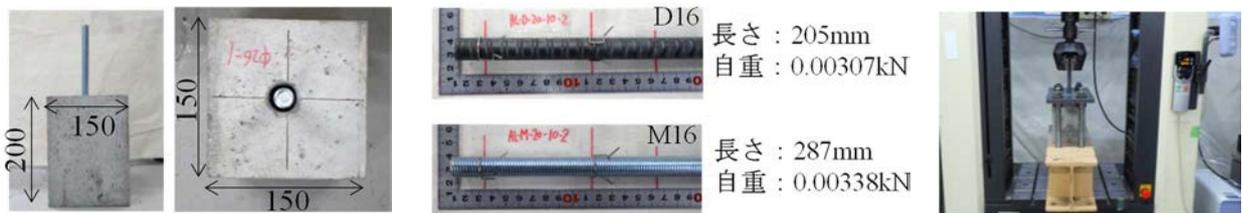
コンクリートブロック 写真-4 クリップ型ばねを装着したアンカー筋 写真-5 試験状況
